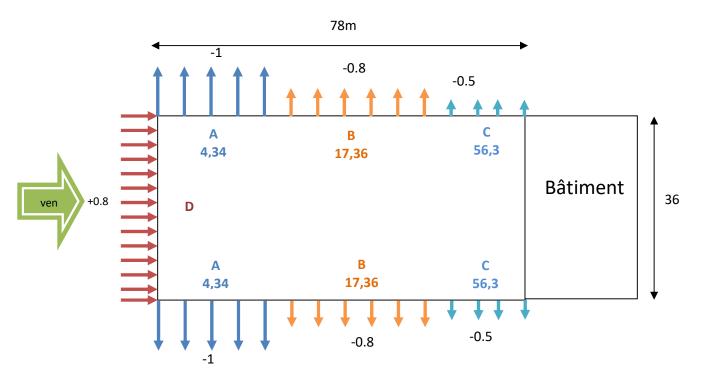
Cpe pour parois verticales (Vent sur pignon).
